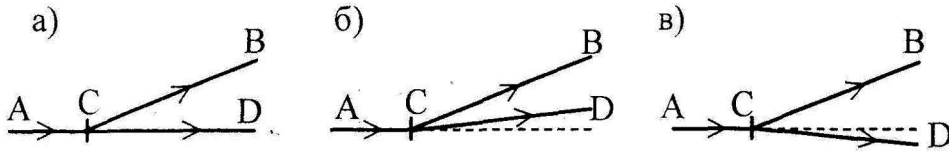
Зображення звичайних стрілочних переводів на немасштабній схемі: а) без перекручувань; б, в) з перекручуваннями
